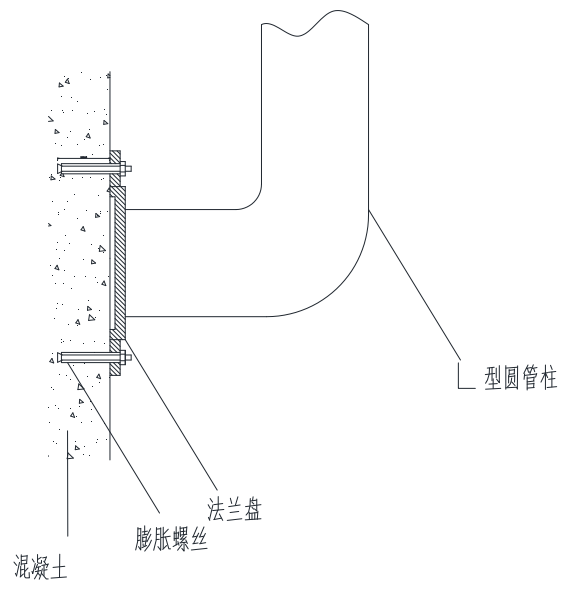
2-2 混凝土侧面监测桩安装示意图
